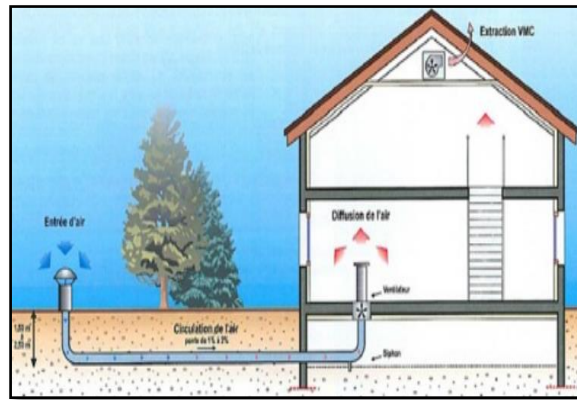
, les principes du puits canadien, Coupe longitudinale sur l'installation d'un puits canadien. *Source : eole-fr.com
